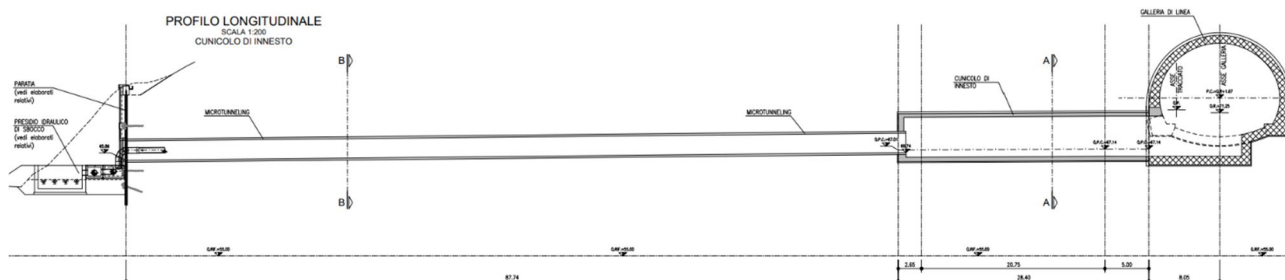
Profilo longitudinale del cunicolo di drenaggio
